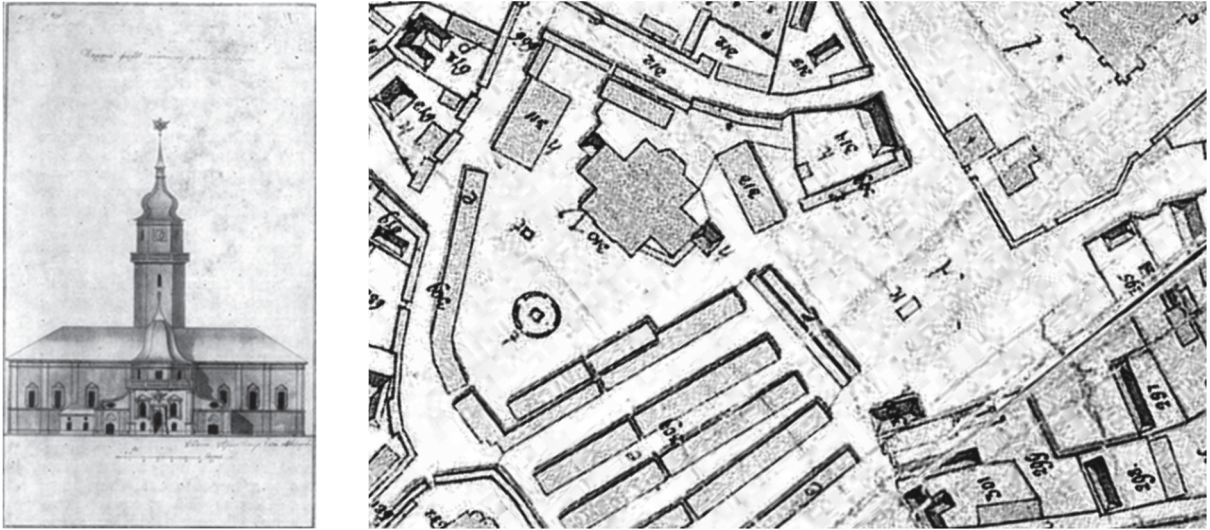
Київська ратуша XVII ст. Головний фасад та генплан
